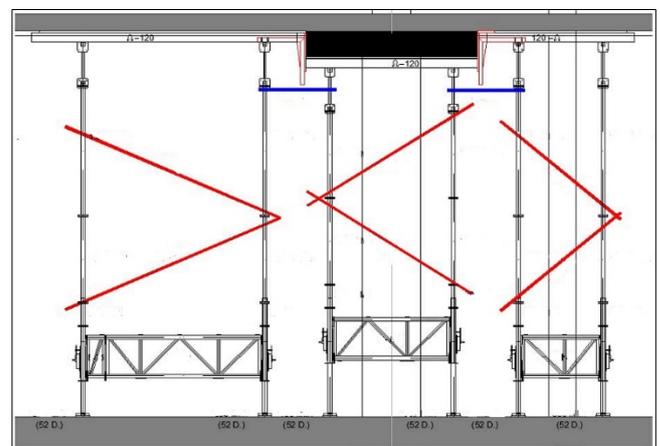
Sistema mesas bajo losa + mesa bajo viga
